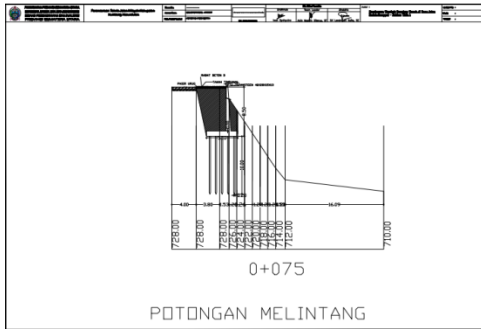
Peta Lokasi (Retaining Wall) Di. Jln.Pakkat-Dolok Sanggul Kabupaten Humbang Hasundutan Dengan STA 0+075
